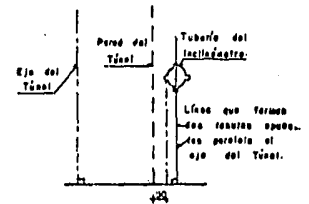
a Detalles de Instrumentación tipo "A". CORTE B-B'
